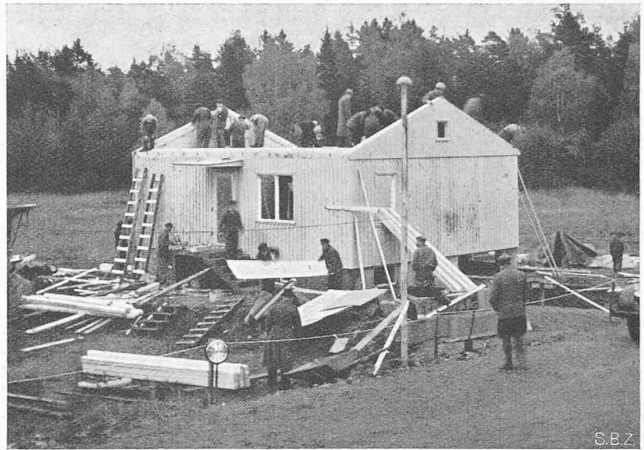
10 h: Wände montiert, Deckenbalken werden gelegt
